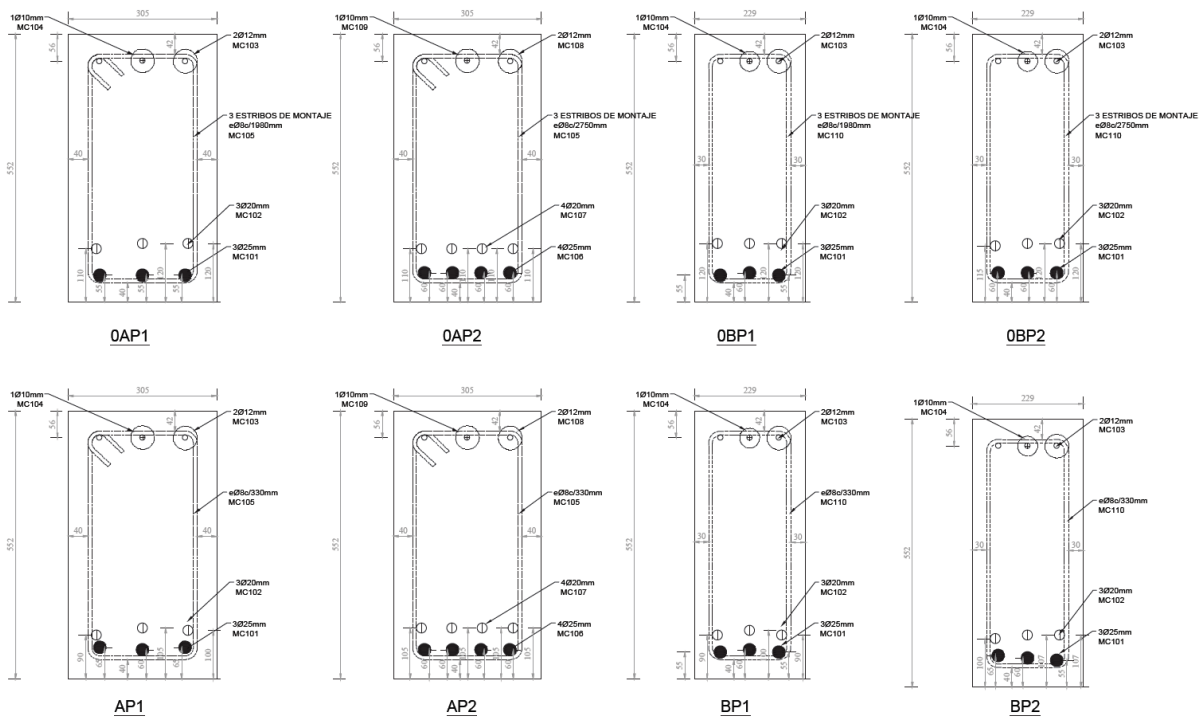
Secciones transversales de la serie de vigas de polipropileno
